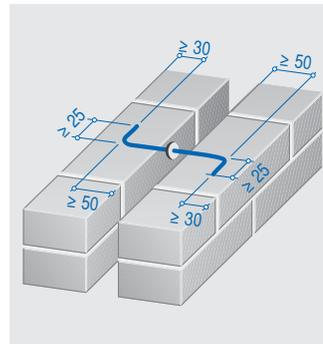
Проволочный анкер/связь для "двухслойной" кладки наружных стен
